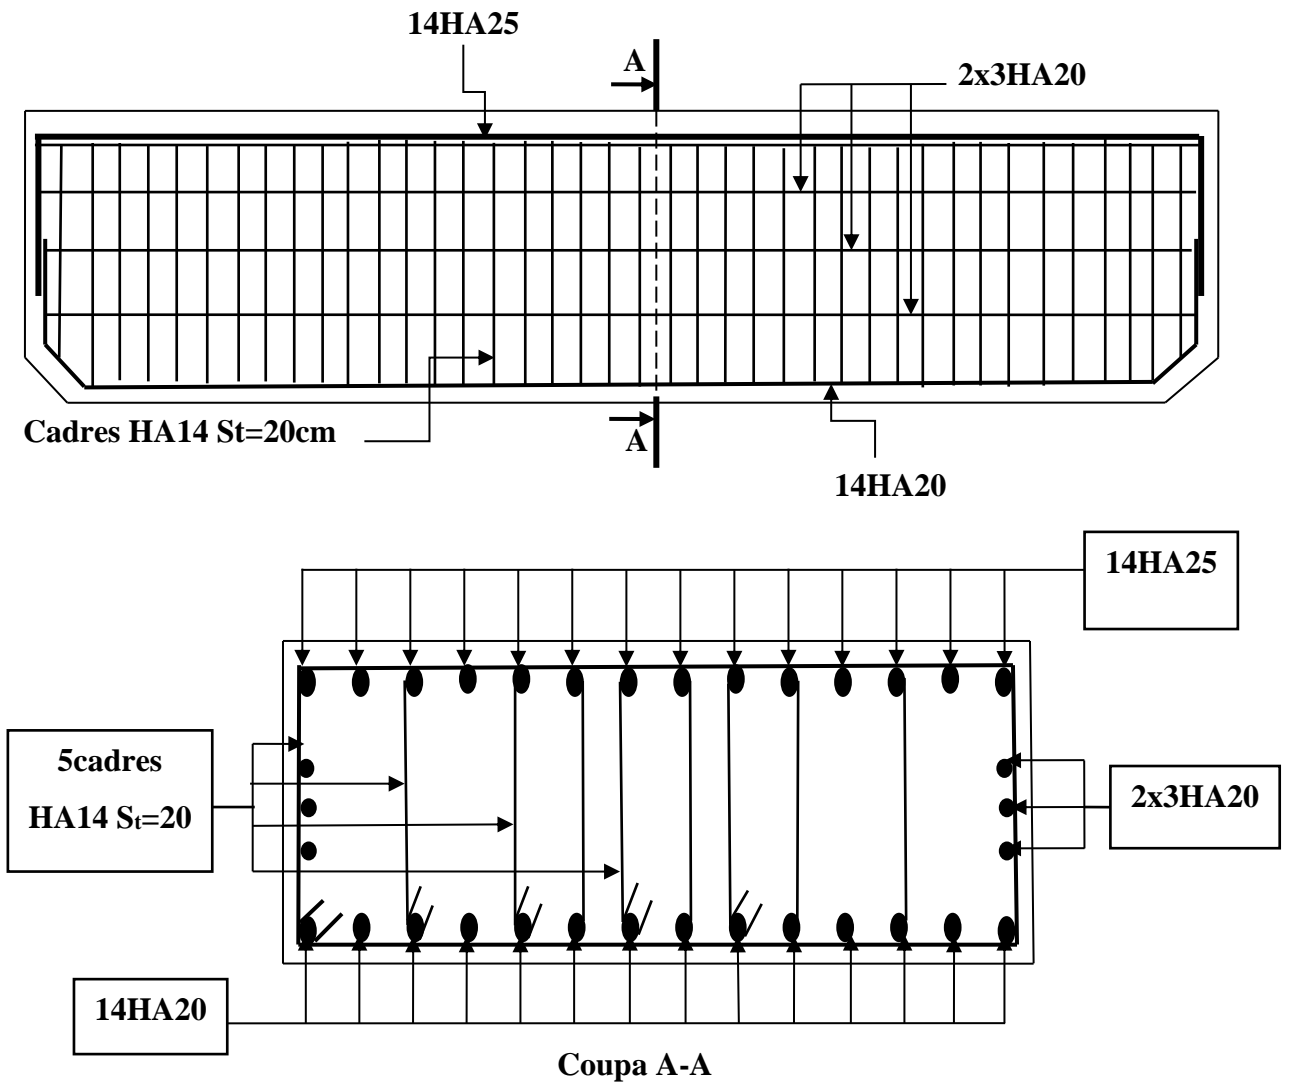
Schéma de ferrailage de chevêtre.
